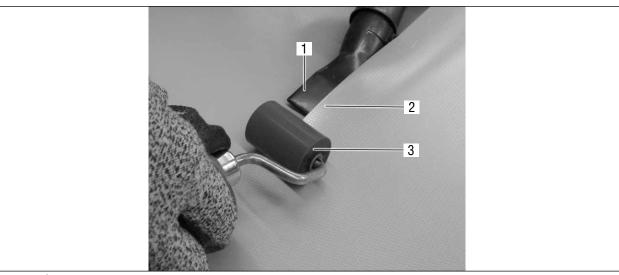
Étanchéité de la membrane de toiture par soudure à l'air chaud
